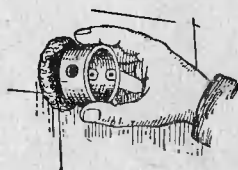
Установка коробки для штепсельной розетки и выключателя.
